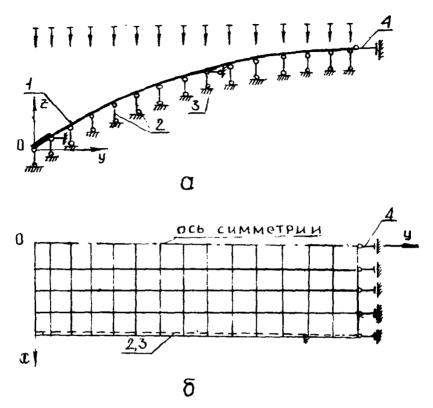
Расчетная схема гибкой пластины-цилинрической оболочки по методу конечных элементов в стадии эксплуатации а-продольный разрез; б-план; 1-пластина; 2 и 3вертикальные и горизонтальные связи; 4-стержиевые соединительные элементы
